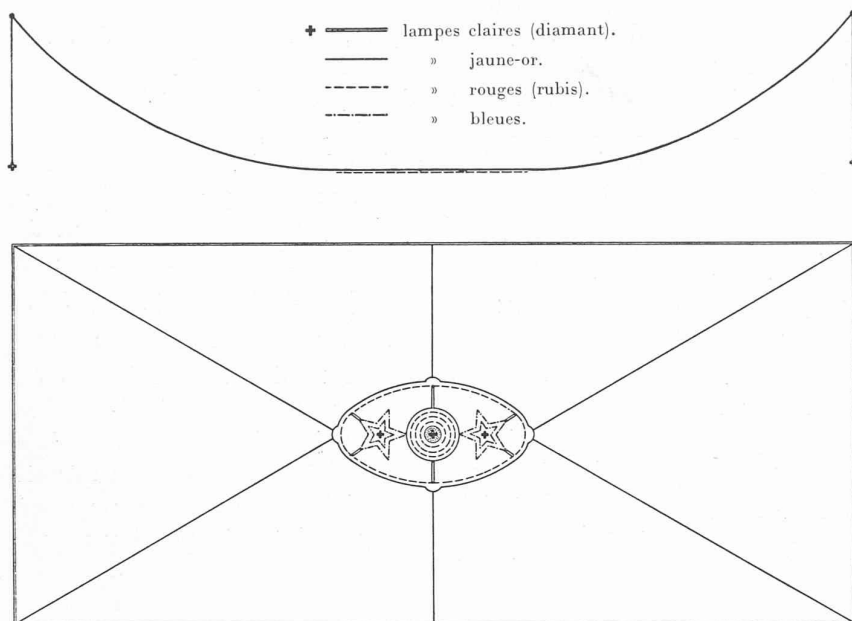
Schéma (plan et élévation) de l'éclairage du plafond.
